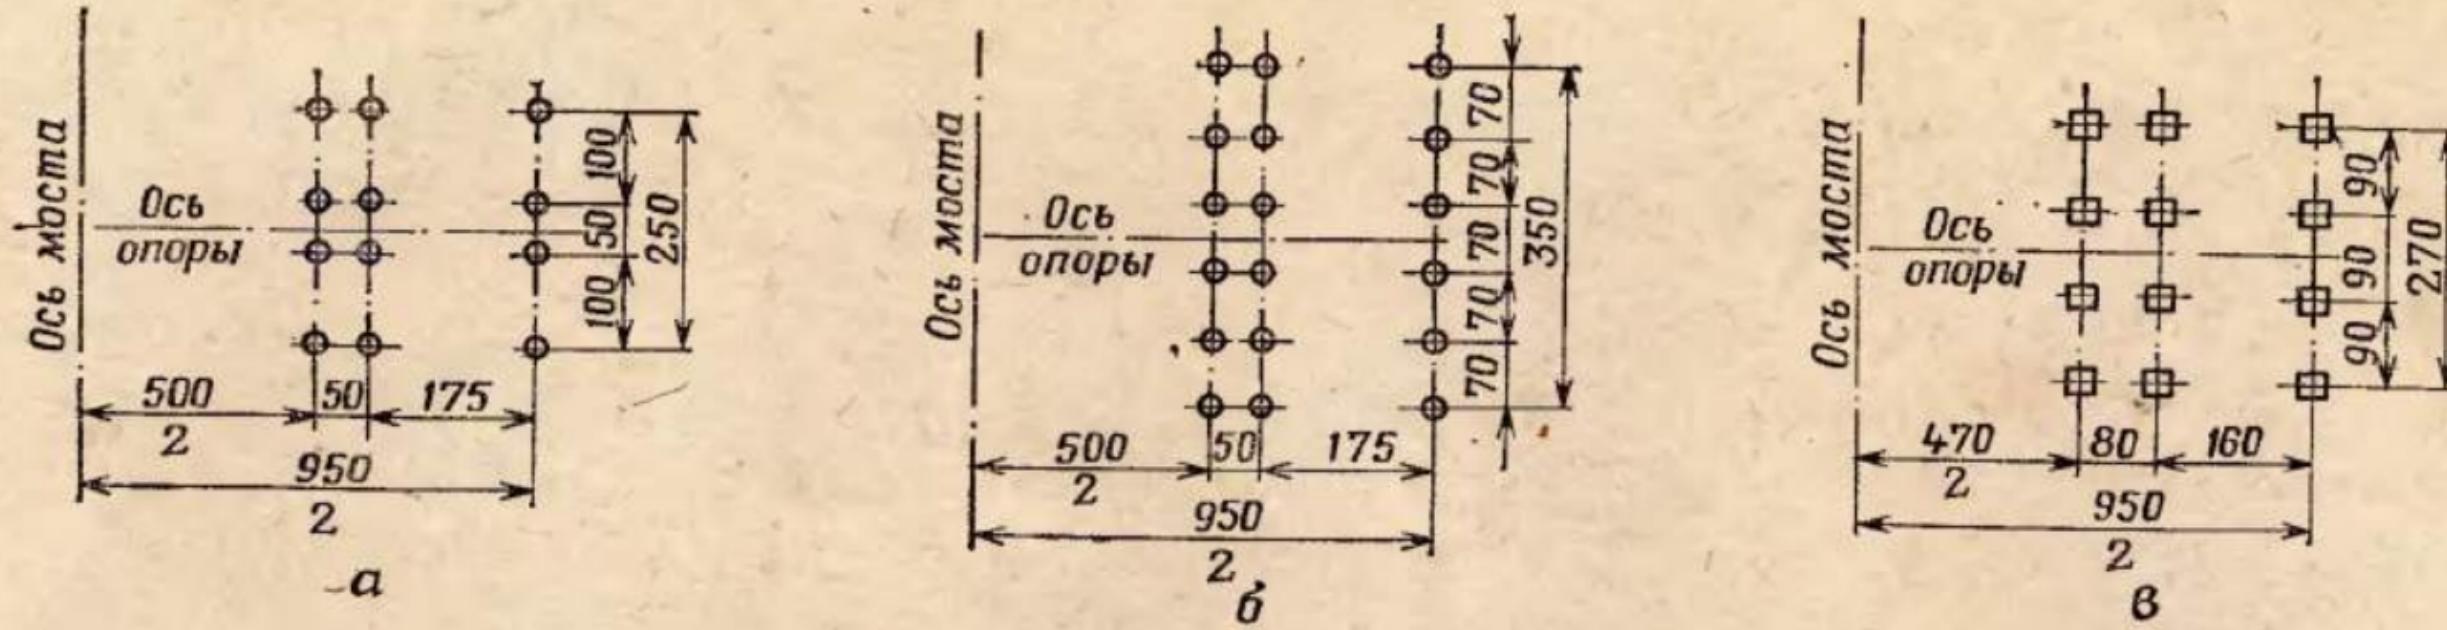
Варианты размещения свай в фундаменте рамной подъемной опоры:
